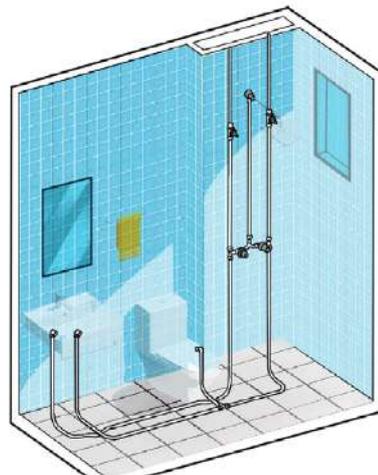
Aplicação do Sistema ClicPEX em instalações prediais de banheiro
